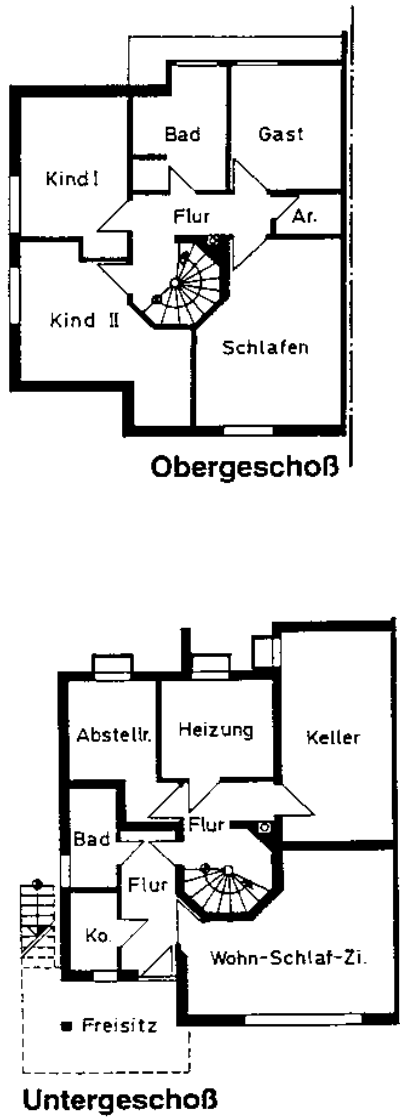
Grundriss und Schnitt des Referenzhauses
